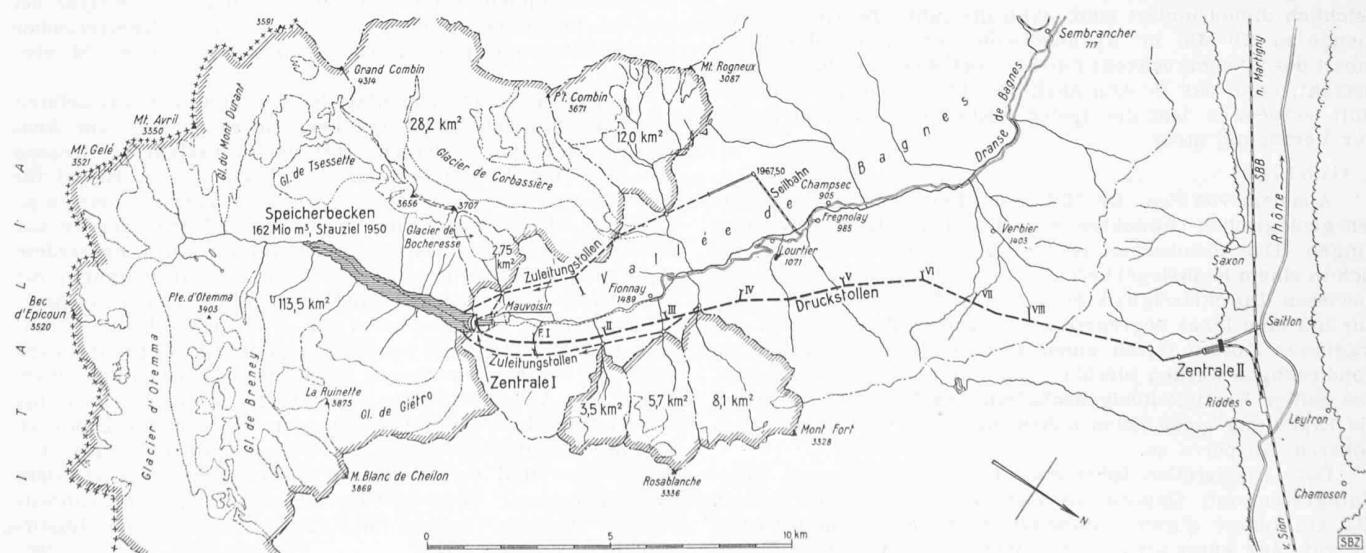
Kraftwerk Mauvoisin, Lageplan mit Einzugsgebiet. Maßstab 1:200 000
